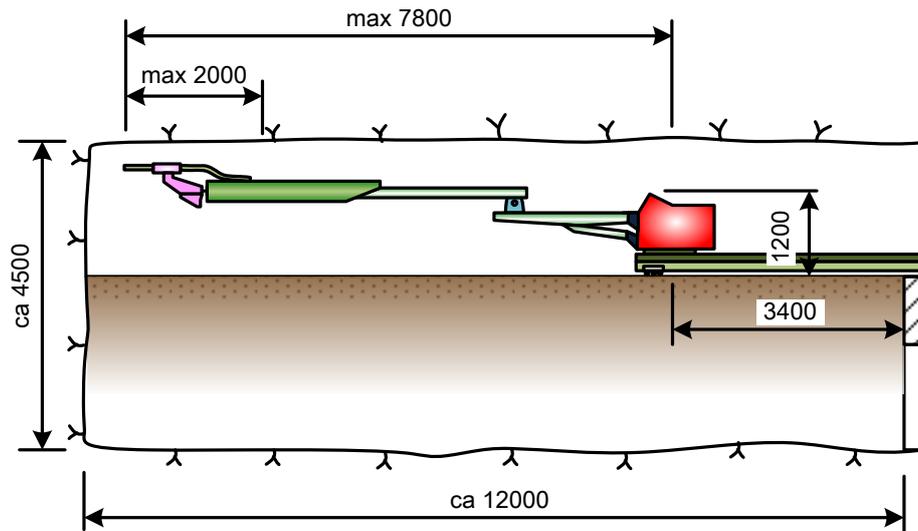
噴注(shotcreting)方式施工(SK B TR-02-12)
